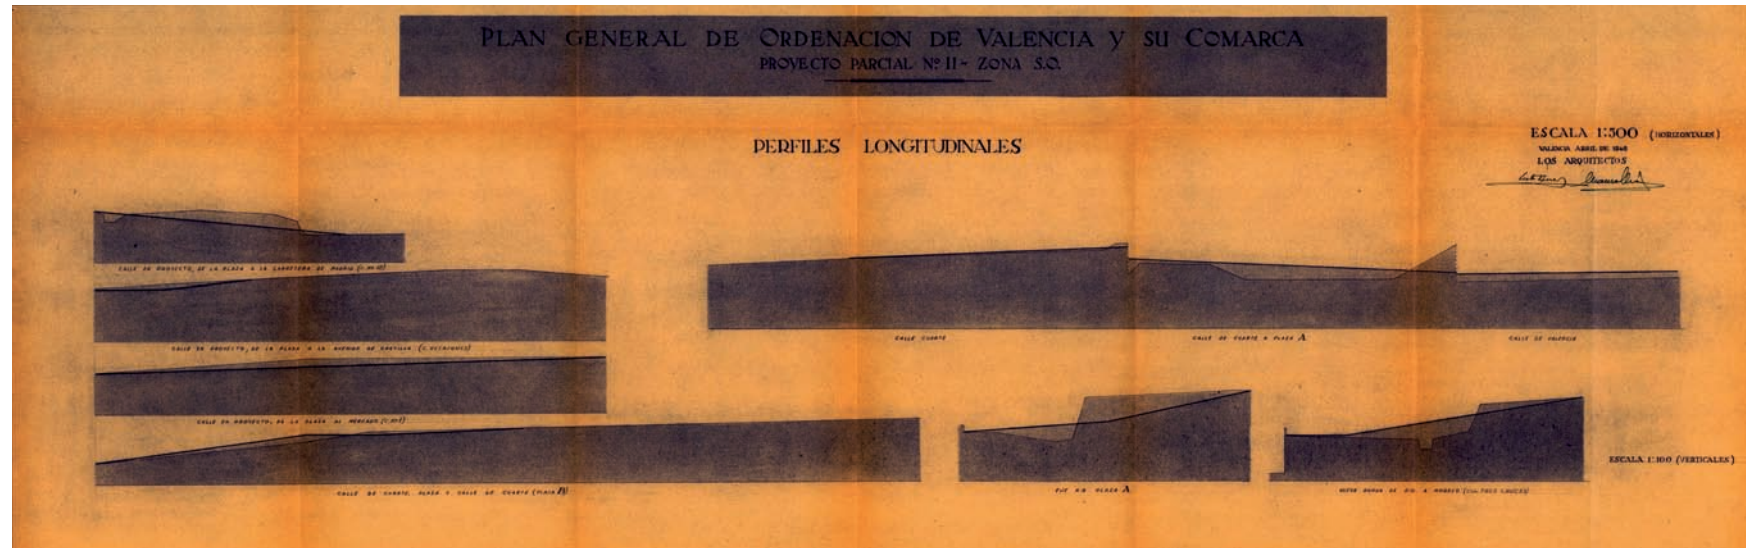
Plano de Perfiles Longitudinales del Proyecto Parcial nº II. Escala 1:500. Abril de 1948. Firmado. Fuente: APAV.
